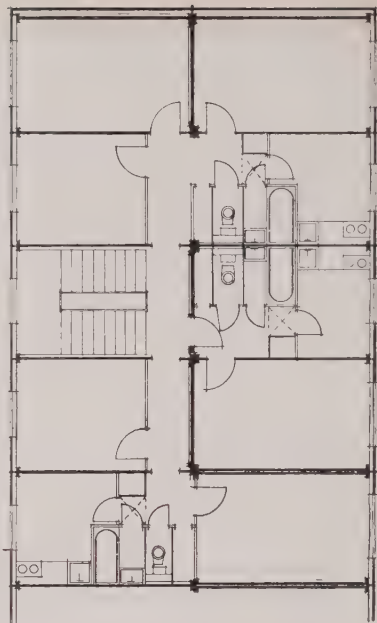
Sektionsgrundriß eines Großplattenhauses
